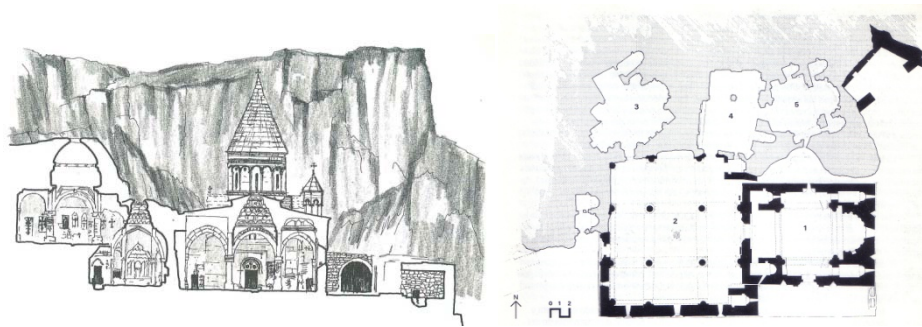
Secció i planta Monestir de Geghard, Armènia (Vvaa, 1997).
